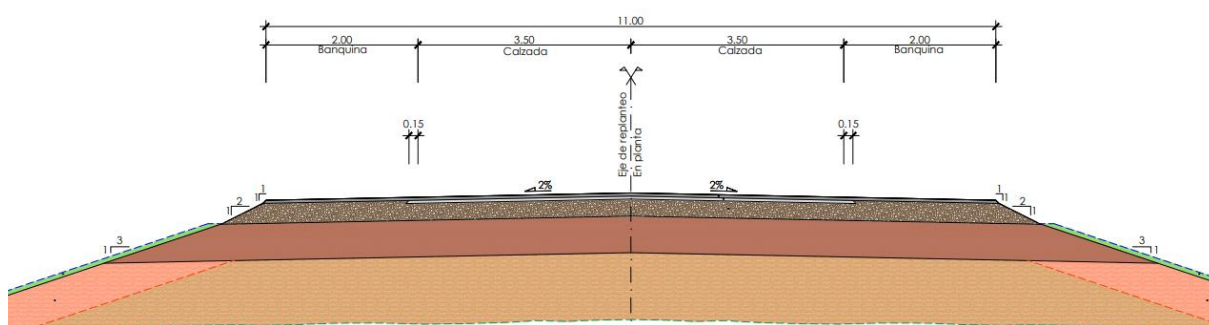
Sección tipo de obra básica y estructura de pavimento, calzada principal
